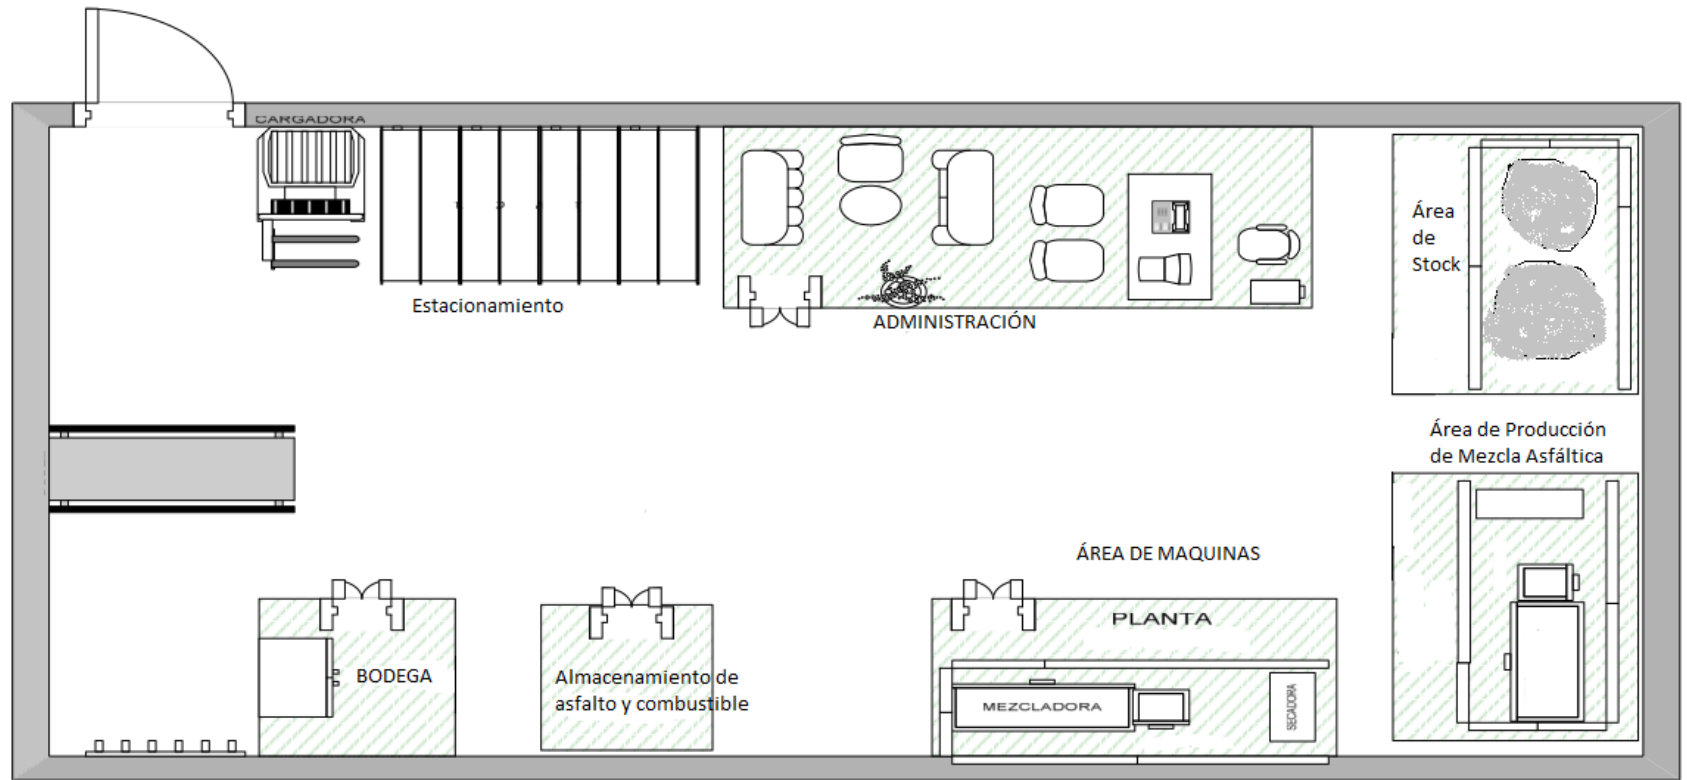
Distribución de las áreas de la planta de hormigón asfáltico
